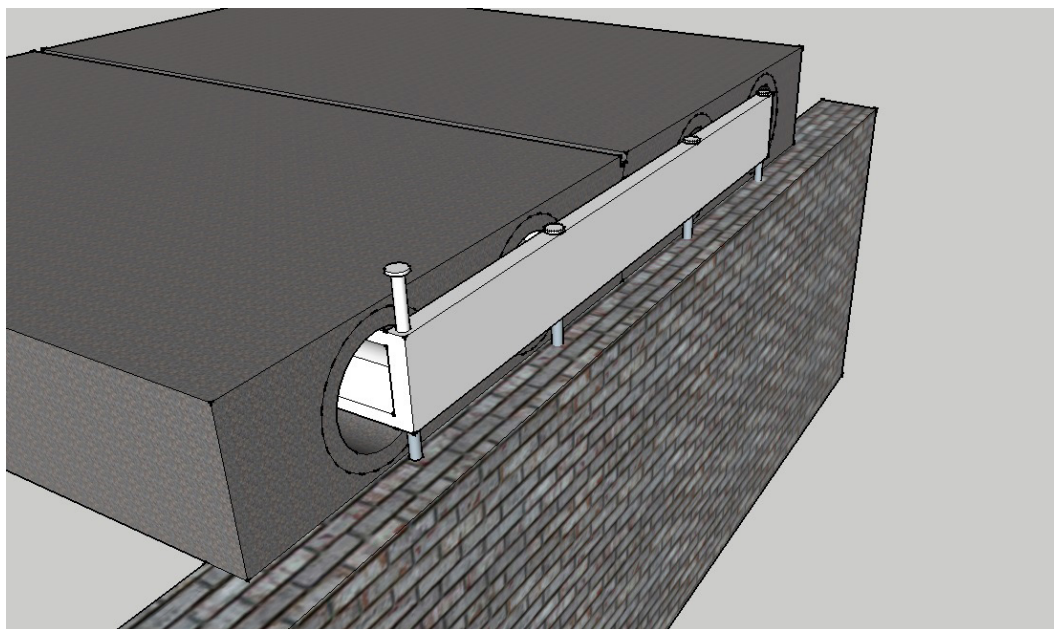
Устройство металлических связей между плитами перекрытия и несущими конструкциями
